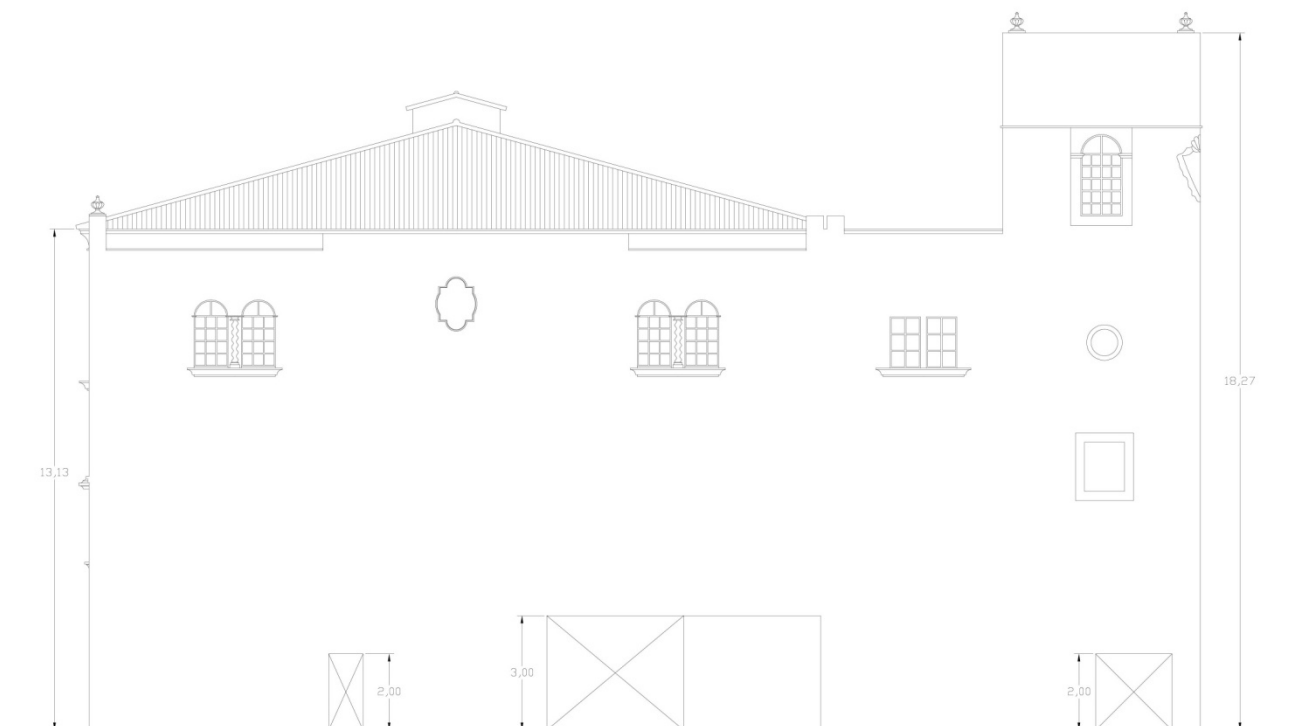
Vista de la fachada Este donde se observa el sistema de recogida de pluviales.
